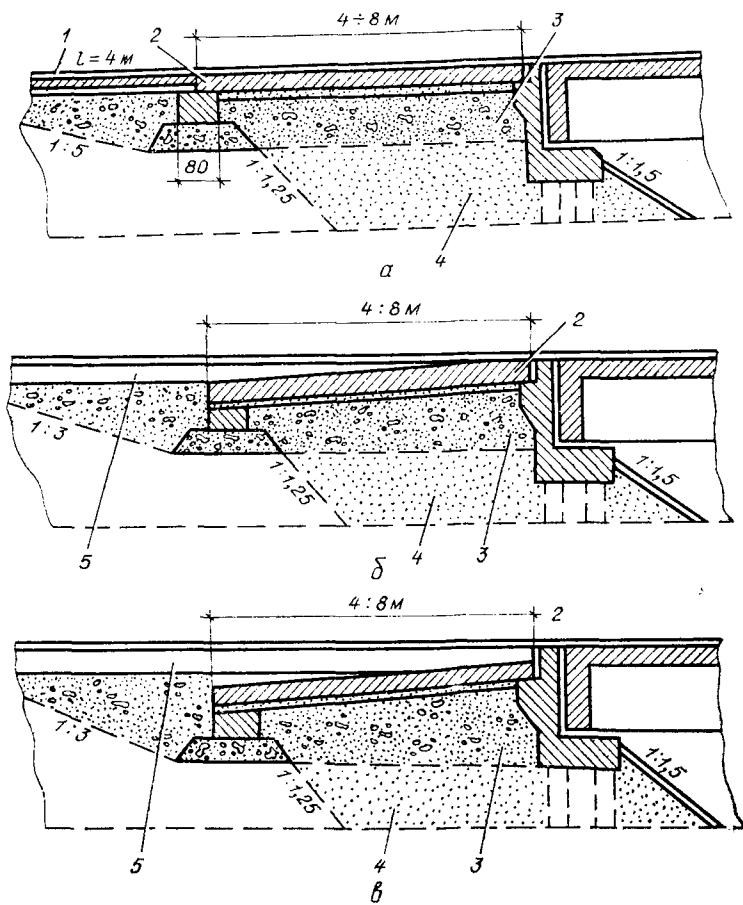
Конструкции сопряжения железобетонных мостов с насыпью:
